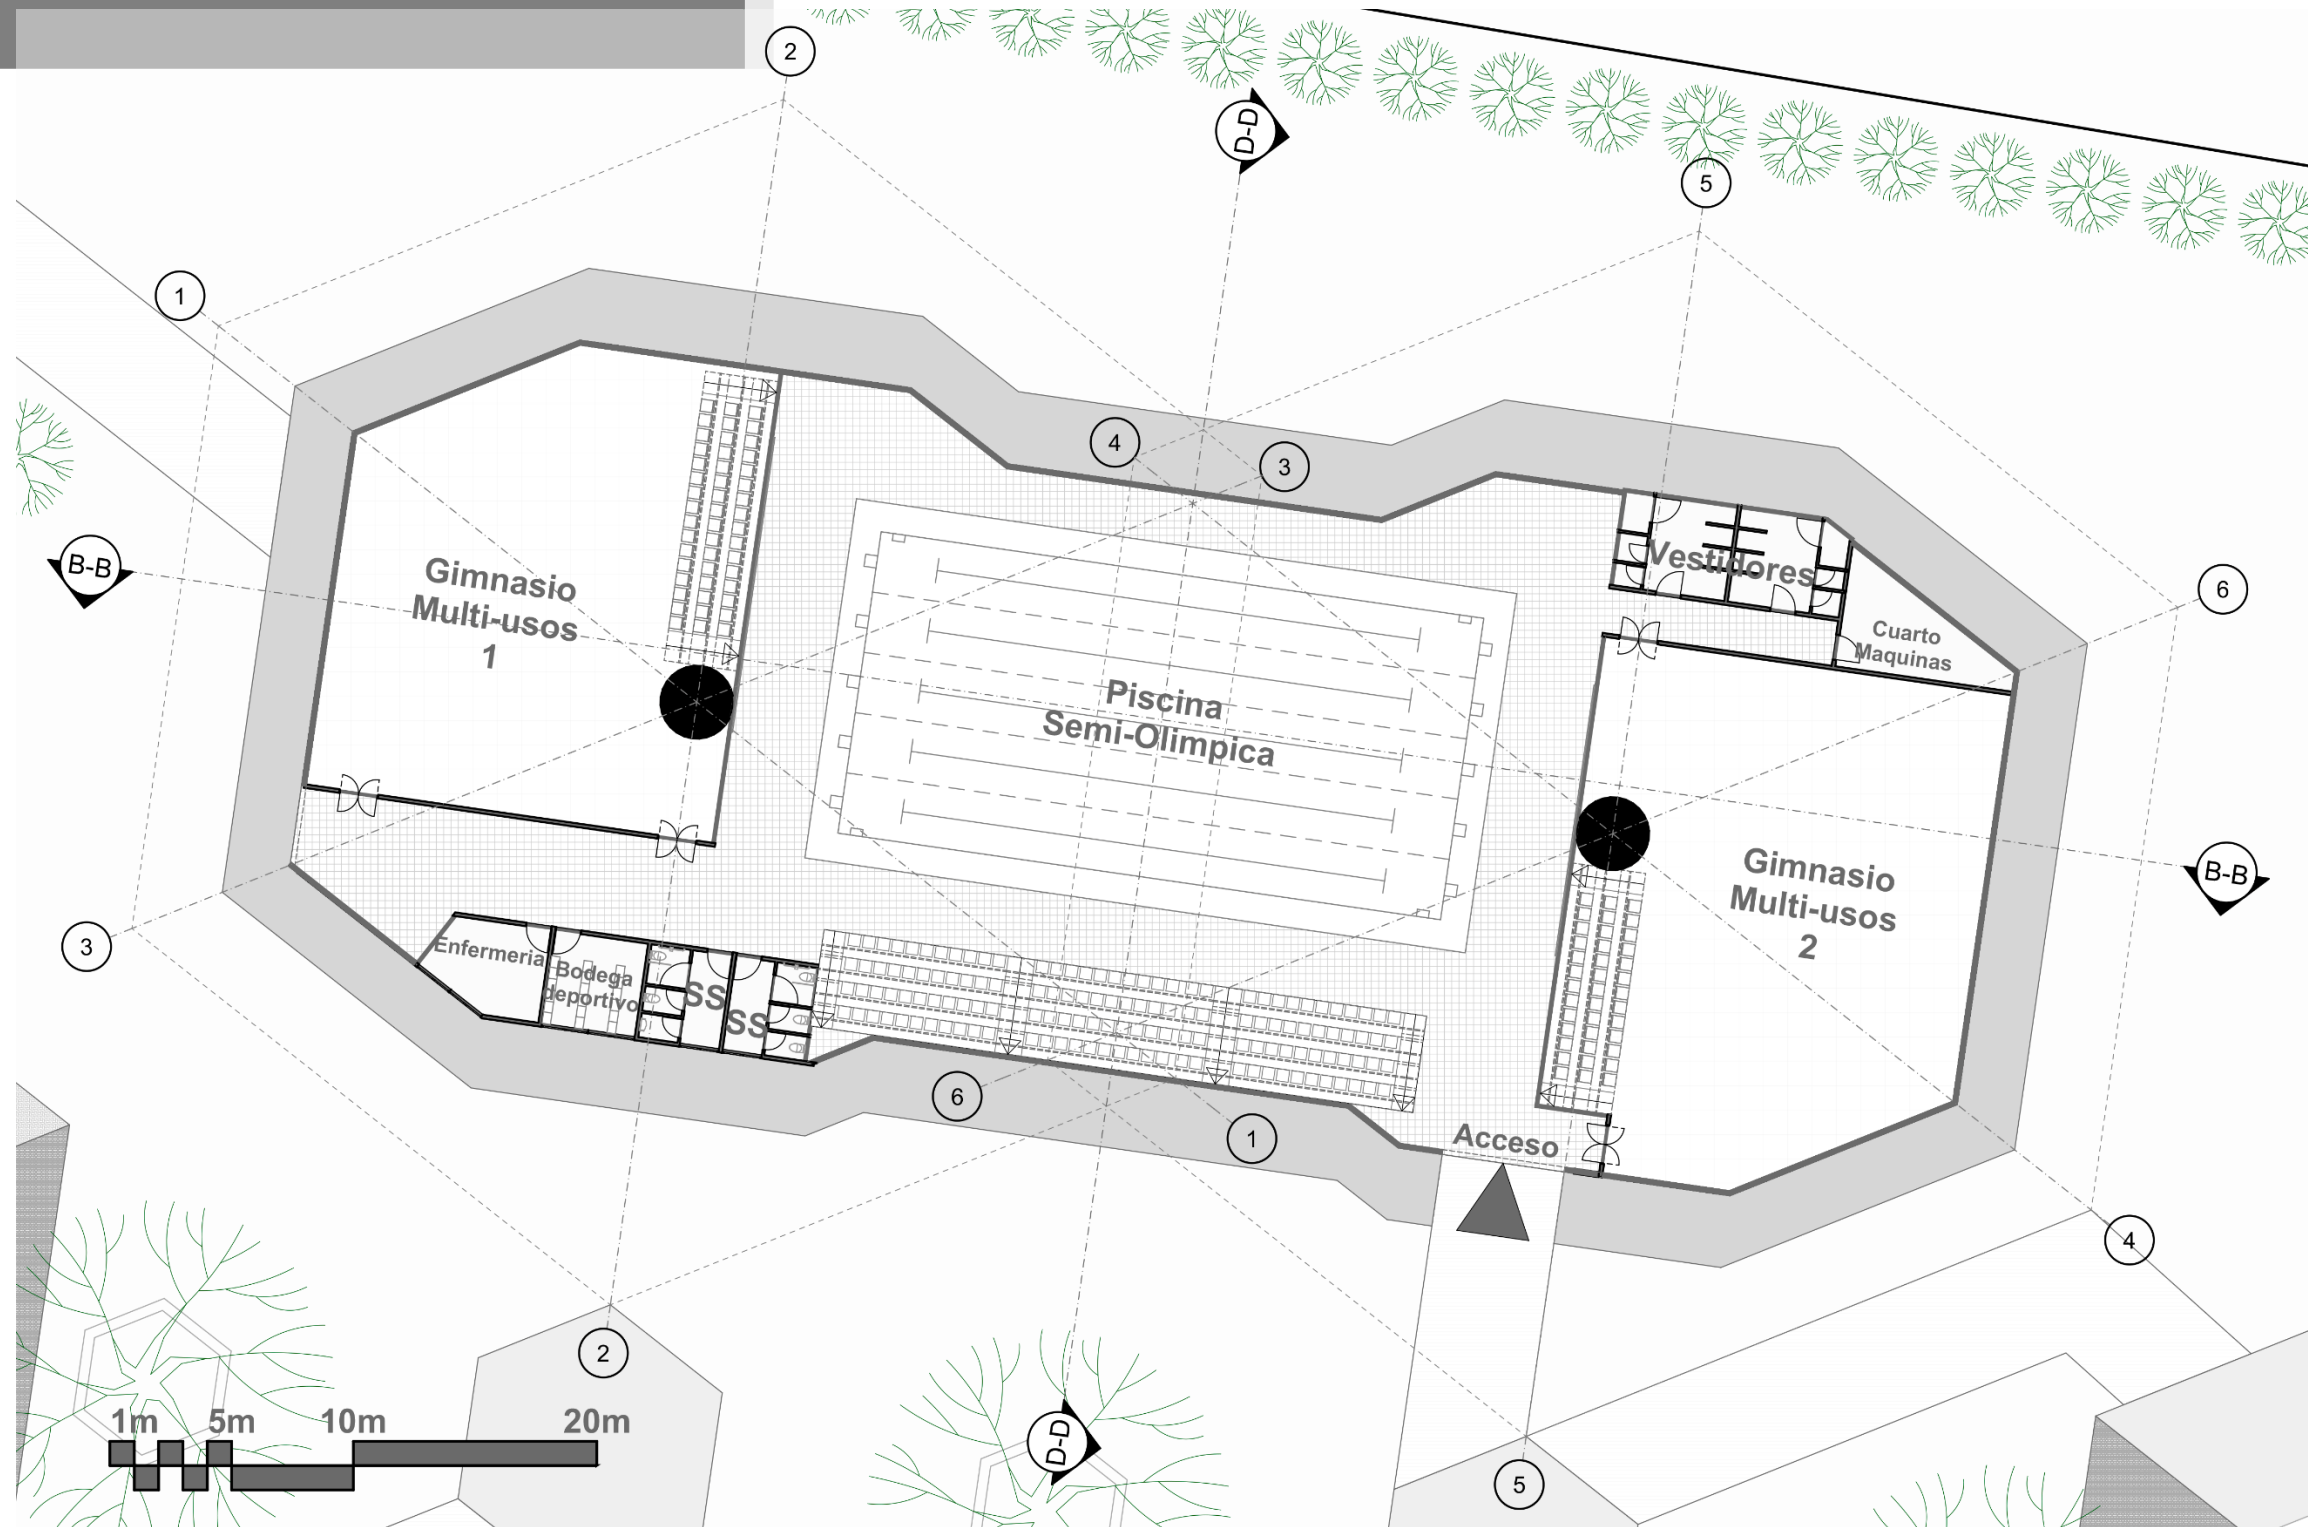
, Planta Arquitectónica Edificio Deportivo, Propiedad Persona, Tomada 2023
